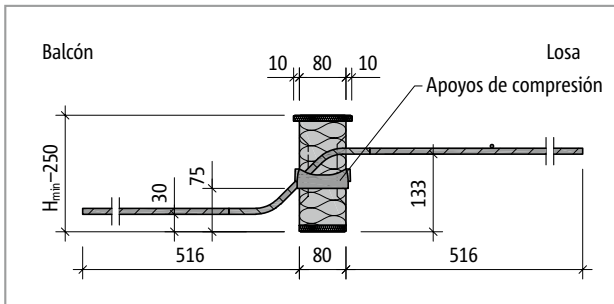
Schöck Isokorb® T tipo Q-V7 y Q-V8: Sección del producto
